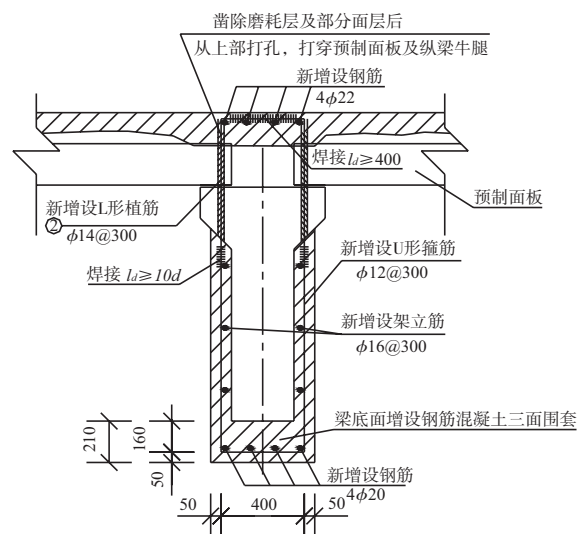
纵梁梁底增设钢筋混凝土三面围套典型结构
